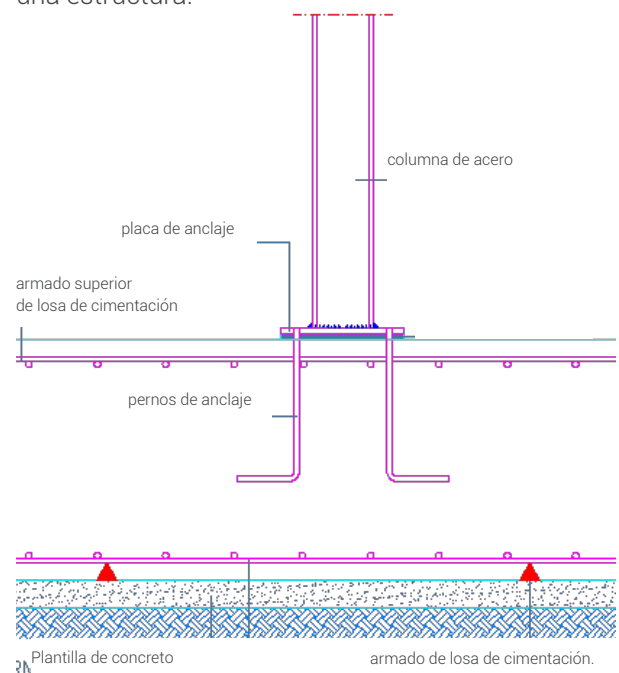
Detalle de anclaje de una columna metálica en una losa de cimentación. Fuente: Elaboración propia.
